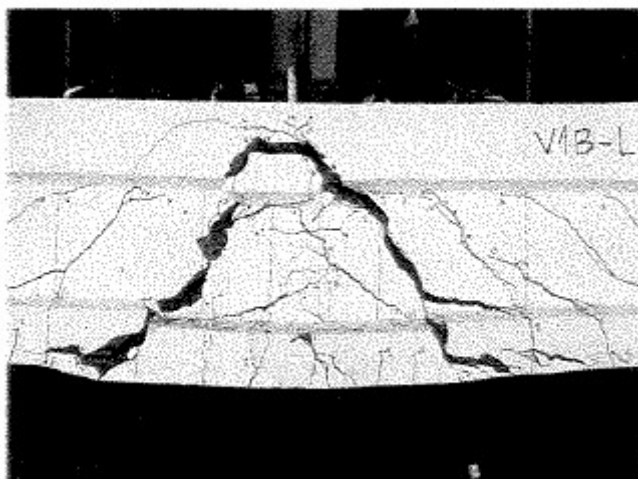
Panorama de fissuração na região de apoio indireto para o conjunto B1-L
